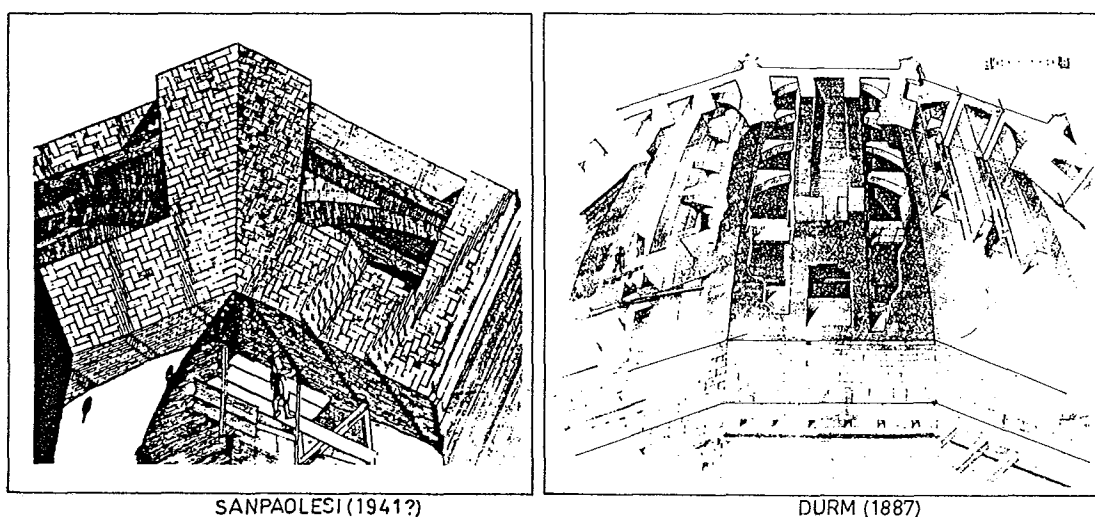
Método constructivo de Brunelleschi para Santa Maria del Fiore
